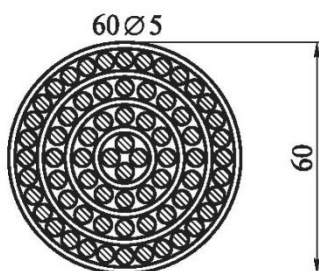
Конструкция пучка напрягаемой арматуры
